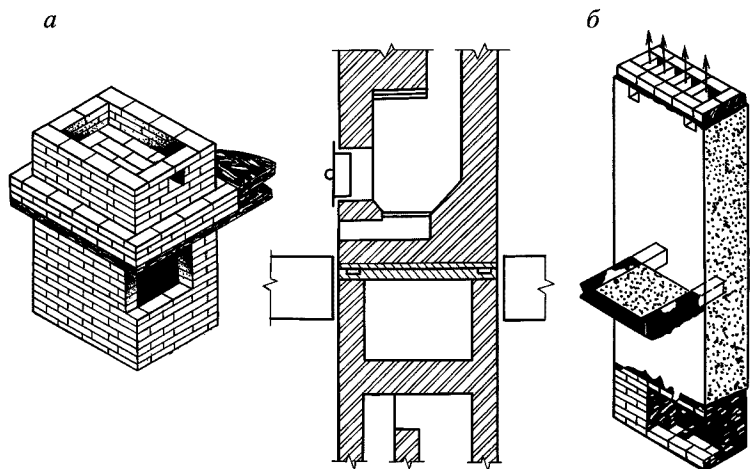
Основания под печи верхнего этажа в деревянных зданиях:
